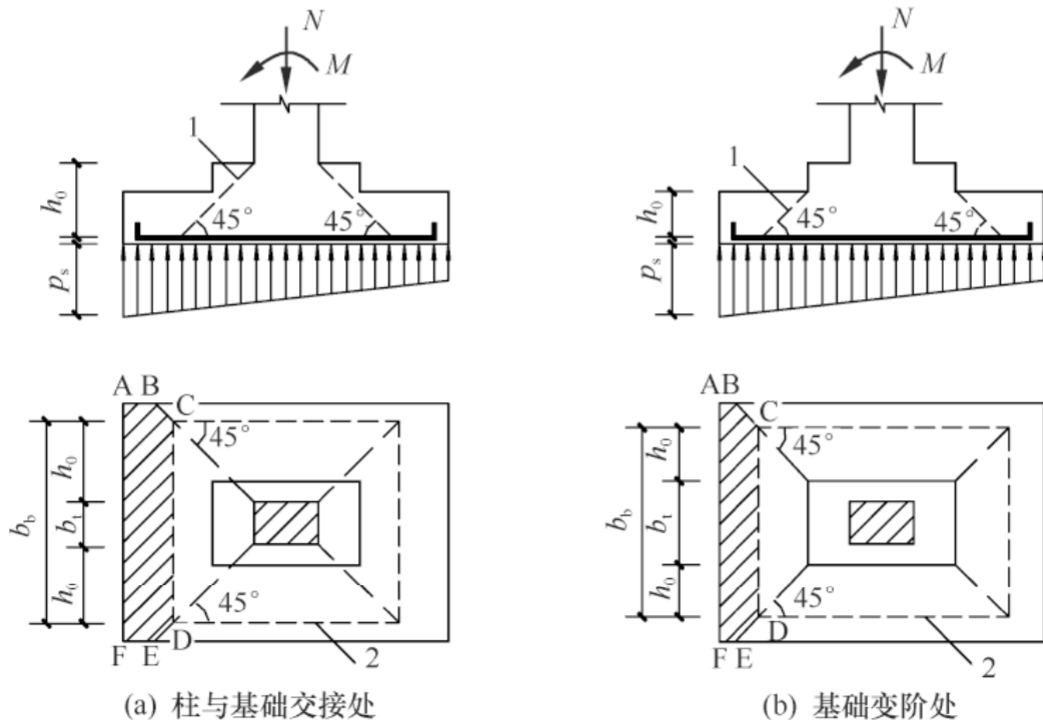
计算阶形基础的受冲切承载力截面位置
